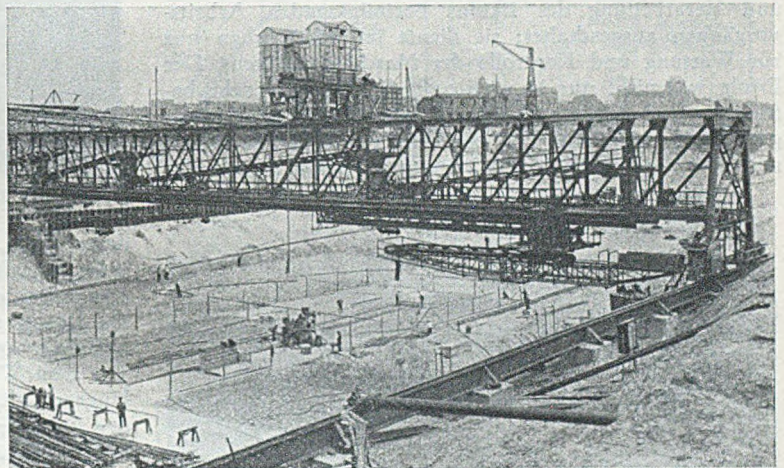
Fahrbare Betonierbrücke mit Förderbändern, im Hintergrund Zementsilos und Abmeßanlage im Aufbau.
